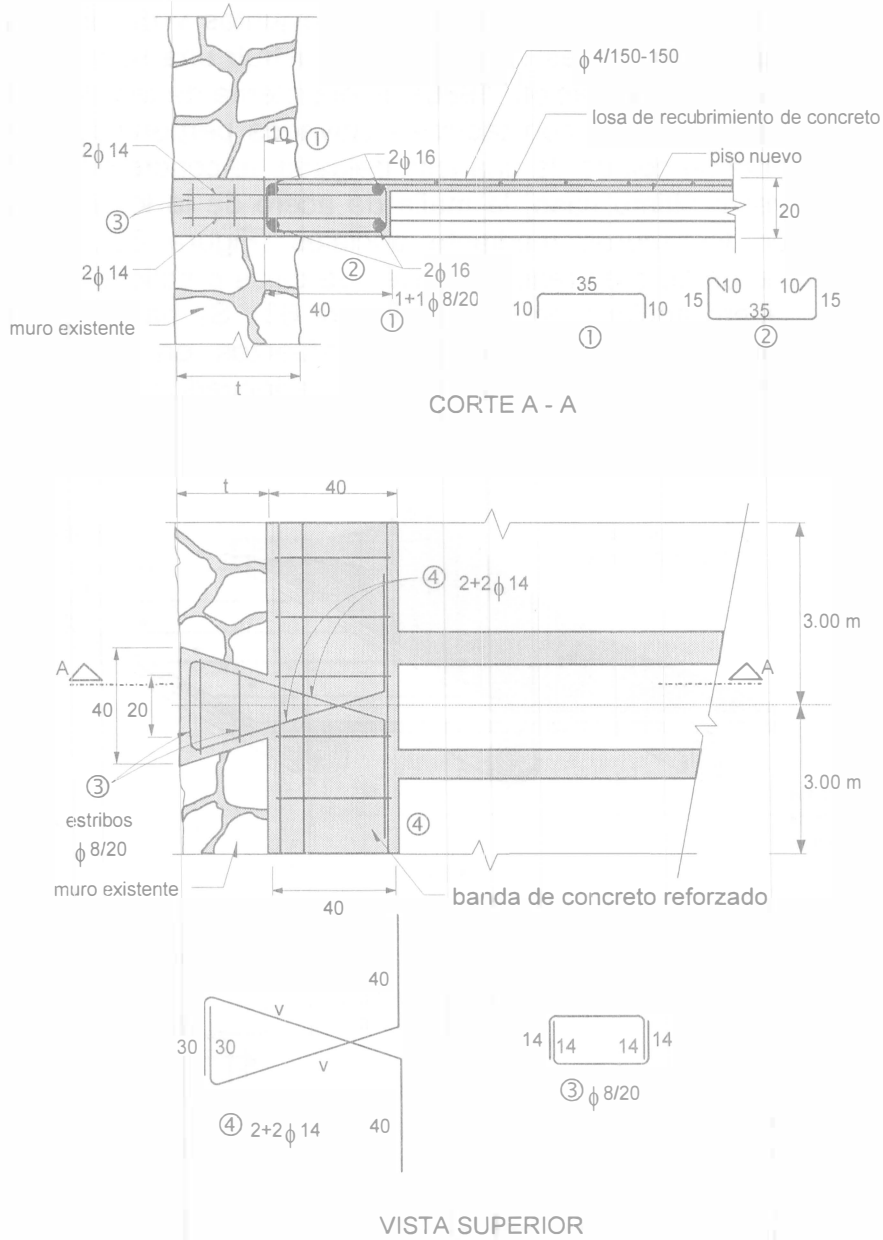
Conexión del nuevo refuerzo de la losa a los muros de carga.
